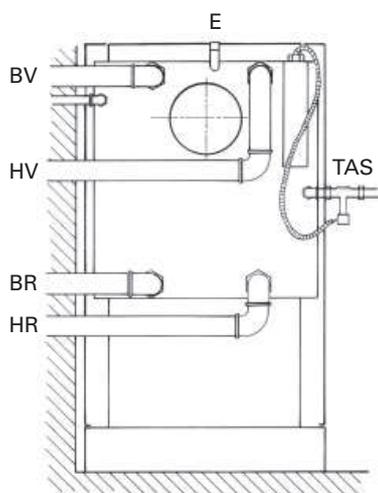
Collegamenti verso un lato e dispositivo di scarico di termprotezione
